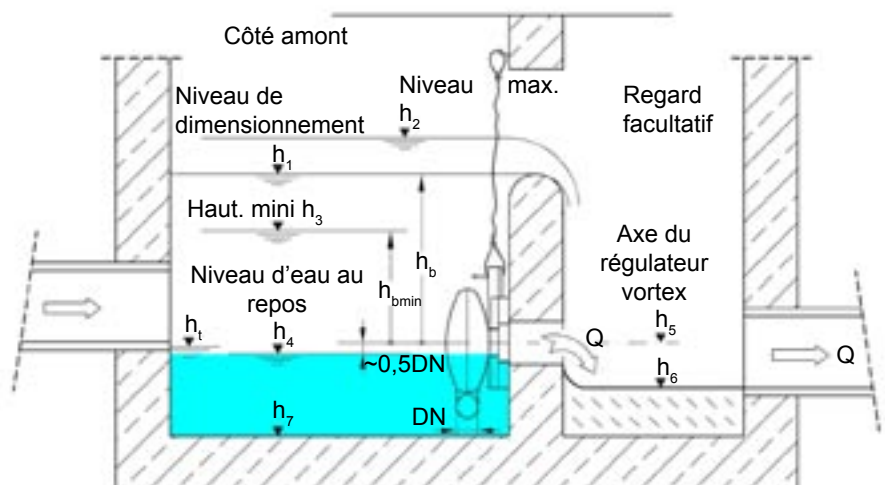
Définition des hauteurs et niveau d'eau pour le dimensionnement hydraulique du régulateur.
